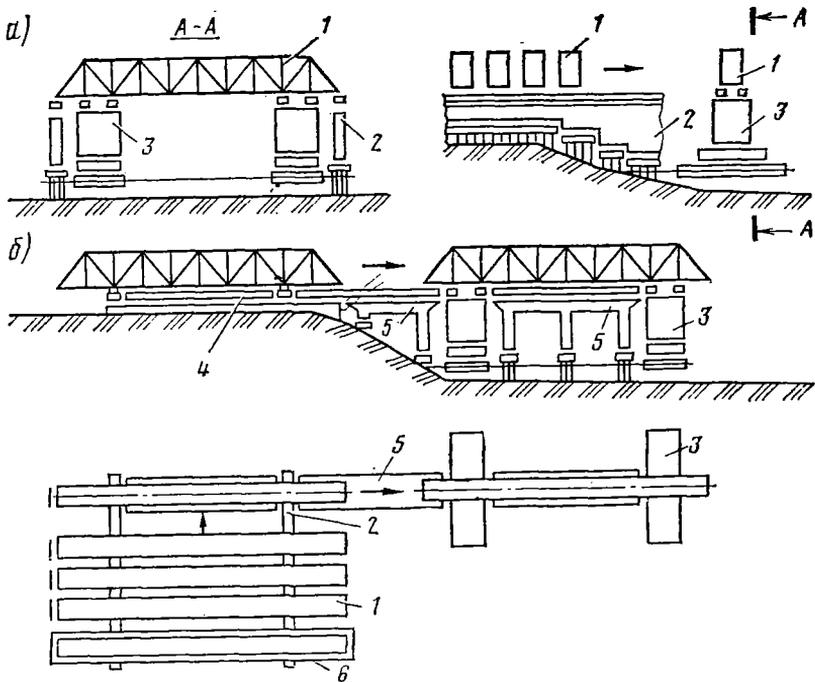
Схема загрузки пролетных строений на плавучие опоры:
